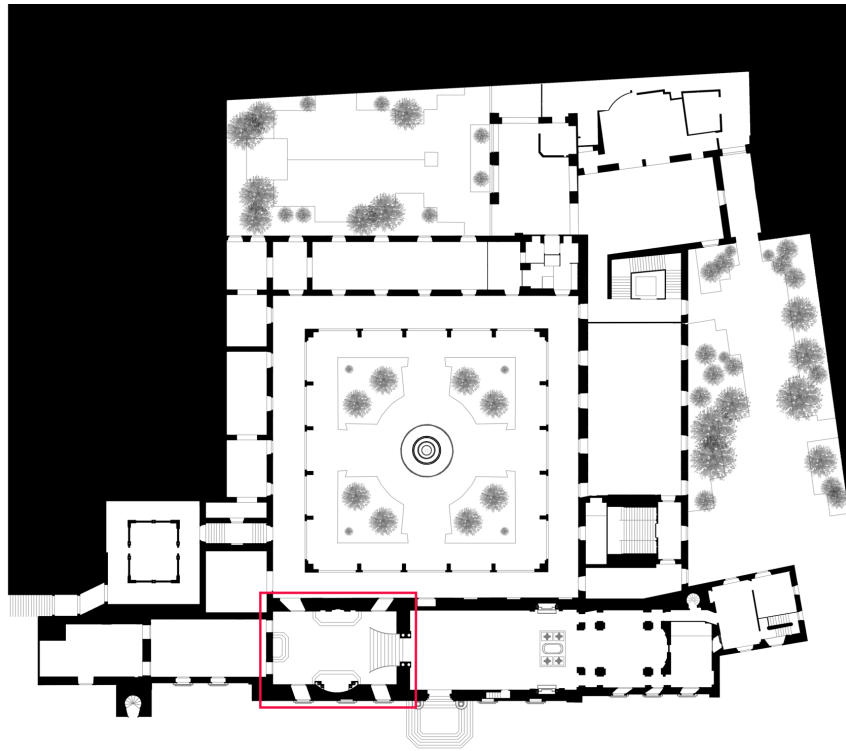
Planta de localização do local em estudo. Coro Baixo.
